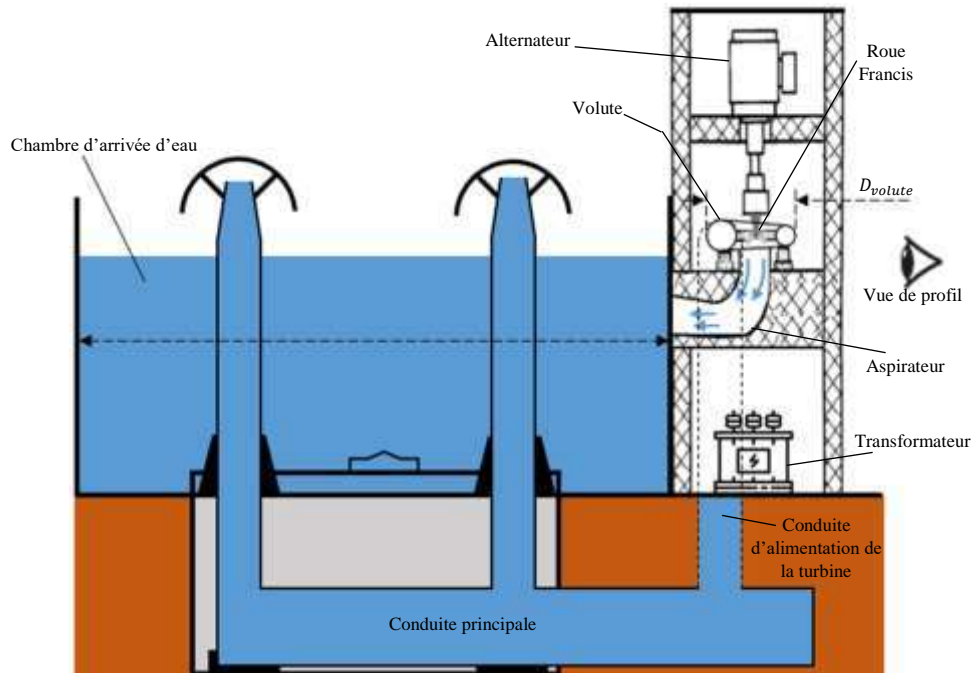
12 : Disposition verticale de la turbine (option2-variante1) et son raccordement au réservoir à travers la paroi (Vue de face)
